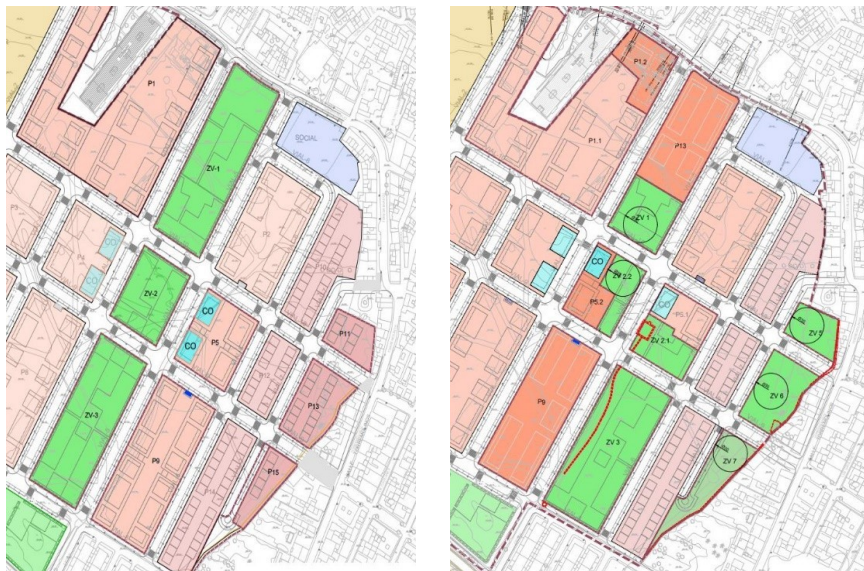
Detalle de la PPO original de 2007 [izq.] y modificación planteada [Dcha.]
